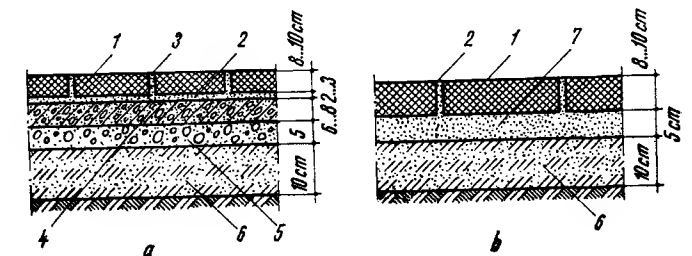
Pardoseli din dale prefabricate de beton:
